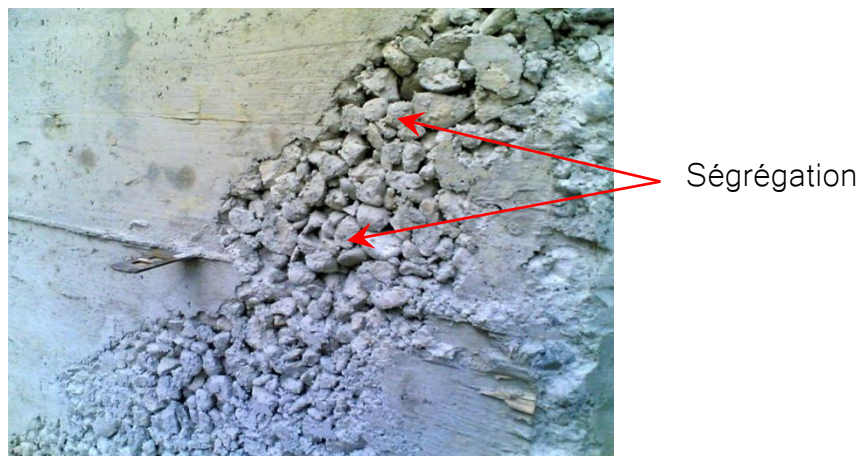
Exemple de désordre du à une mauvaise mise en œuvre du béton : mauvaise vibration du béton.
